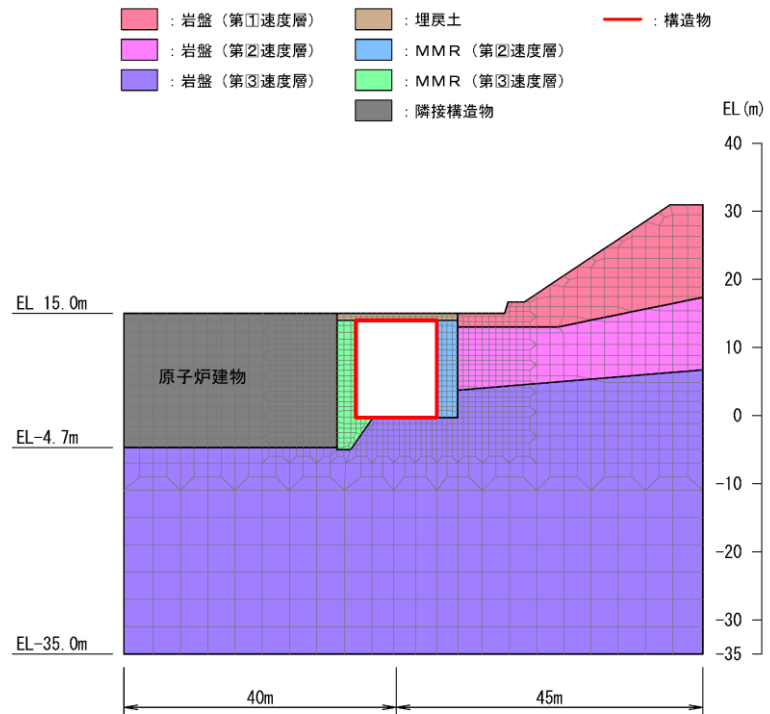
低圧原子炉代替注水ポンプ格納槽 地震応答解析モデル図 (B-B 断面)
